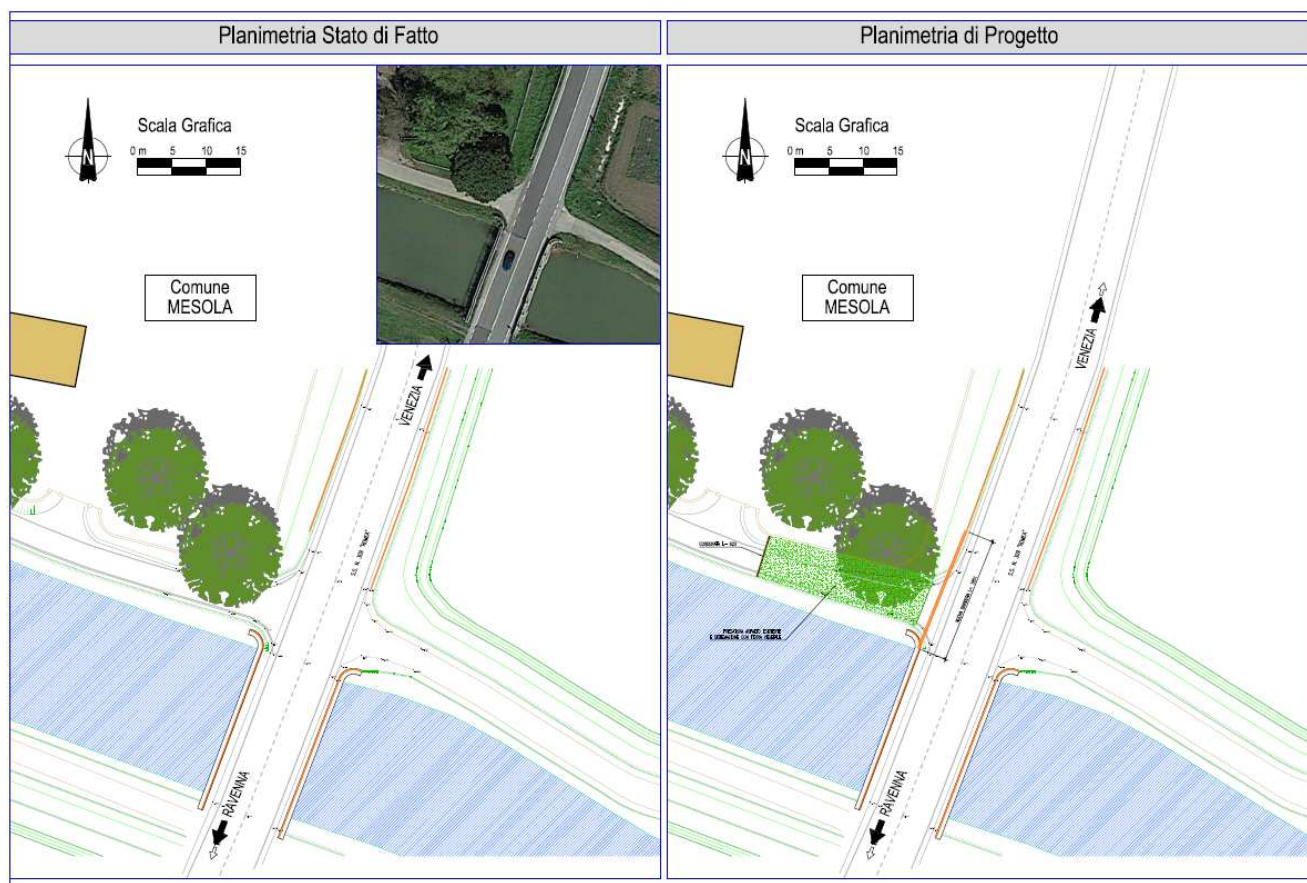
Intervento n°24 – Planimetria Stato di fatto - Progetto
